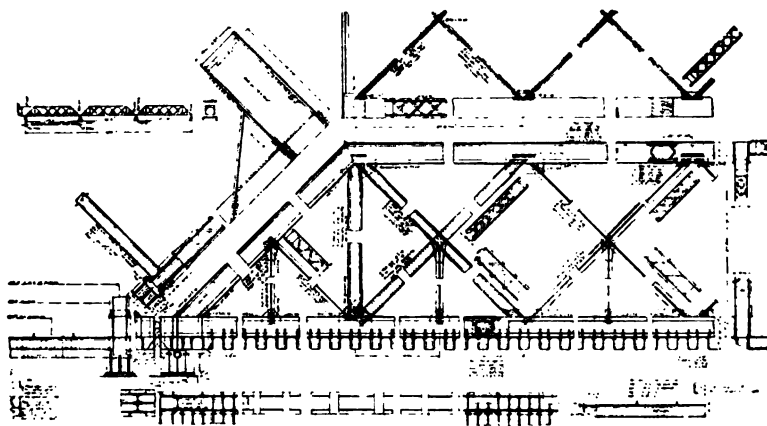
Poutre triangulaire double et complexe. (Travée de 52^m,11, sur le N. Y. C. & H. R. R. R. (Engineering News).
